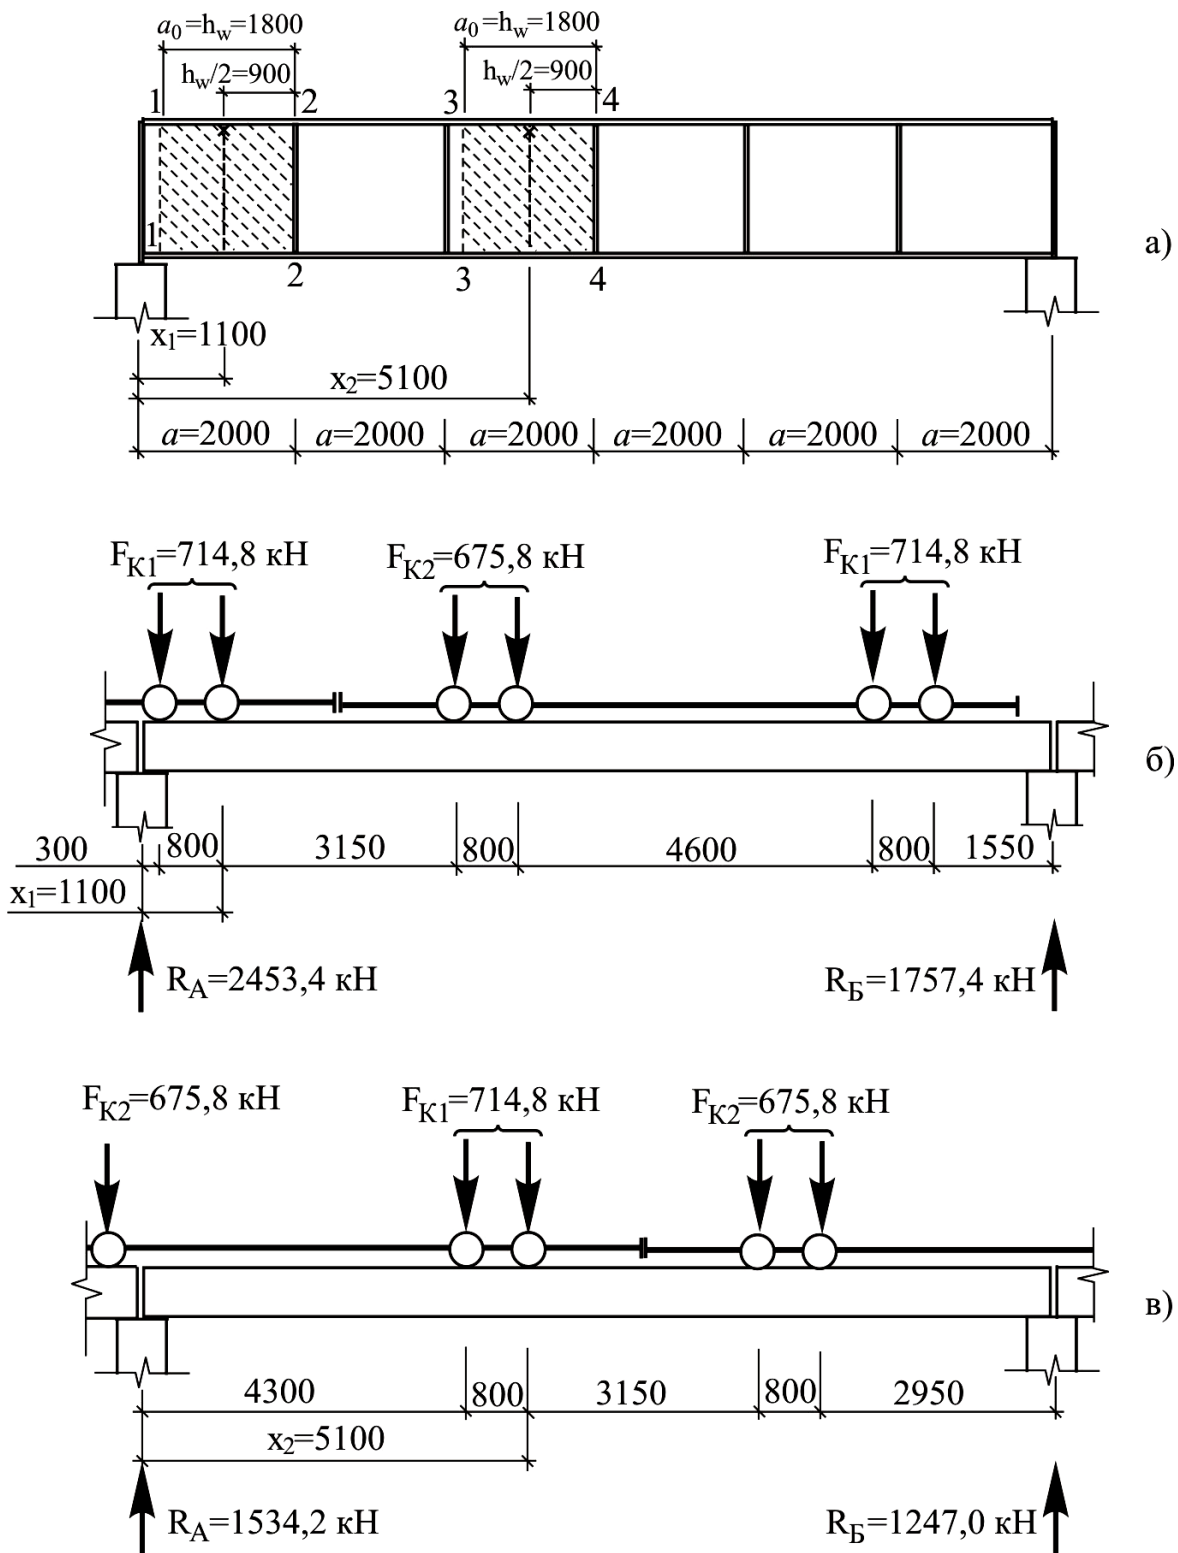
К расчёту местной устойчивости стенки подкрановой балки
